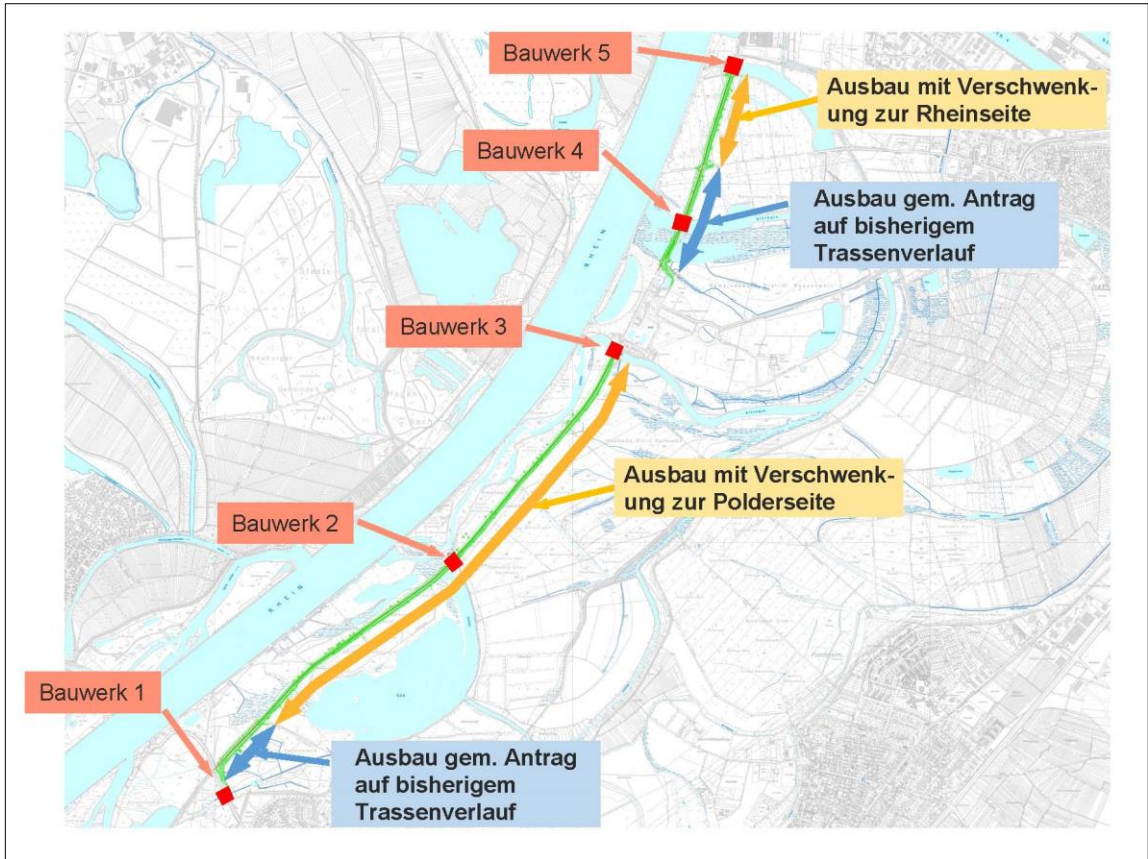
Lageplan mit jeweiligen Verschwenkungen
